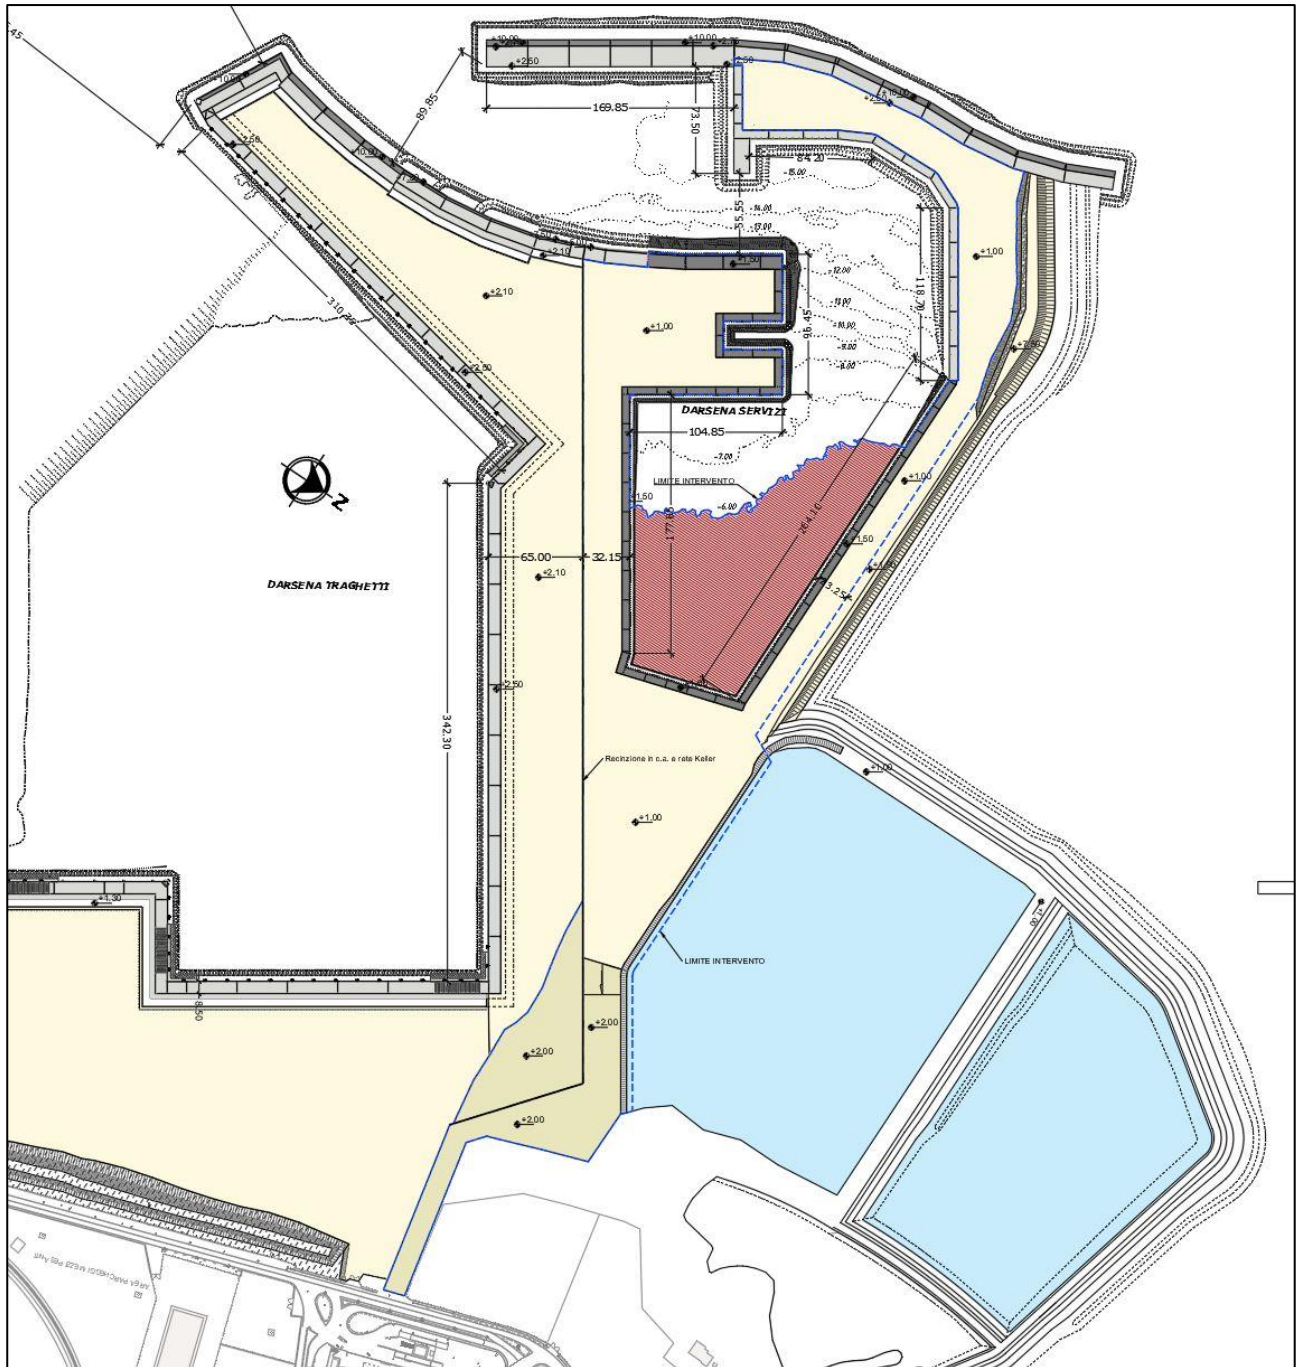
Darsena Servizi: Planimetria delle opere di banchinamento interno e dell'area di dragaggio
